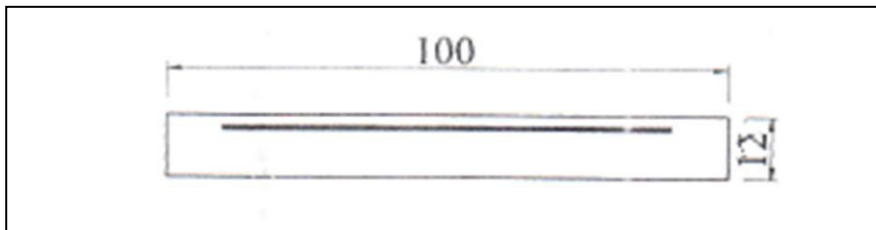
Section théorique de pour le ferrailage de l'acrotère.
